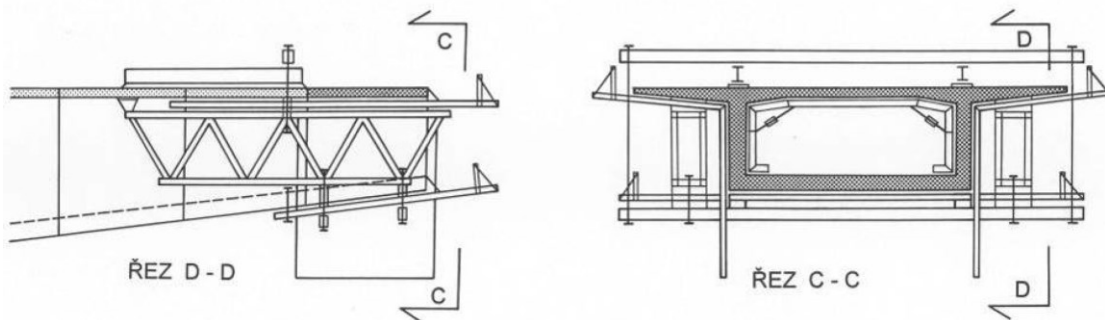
Typický příčný řez letmo betonovaného mostu [15]
